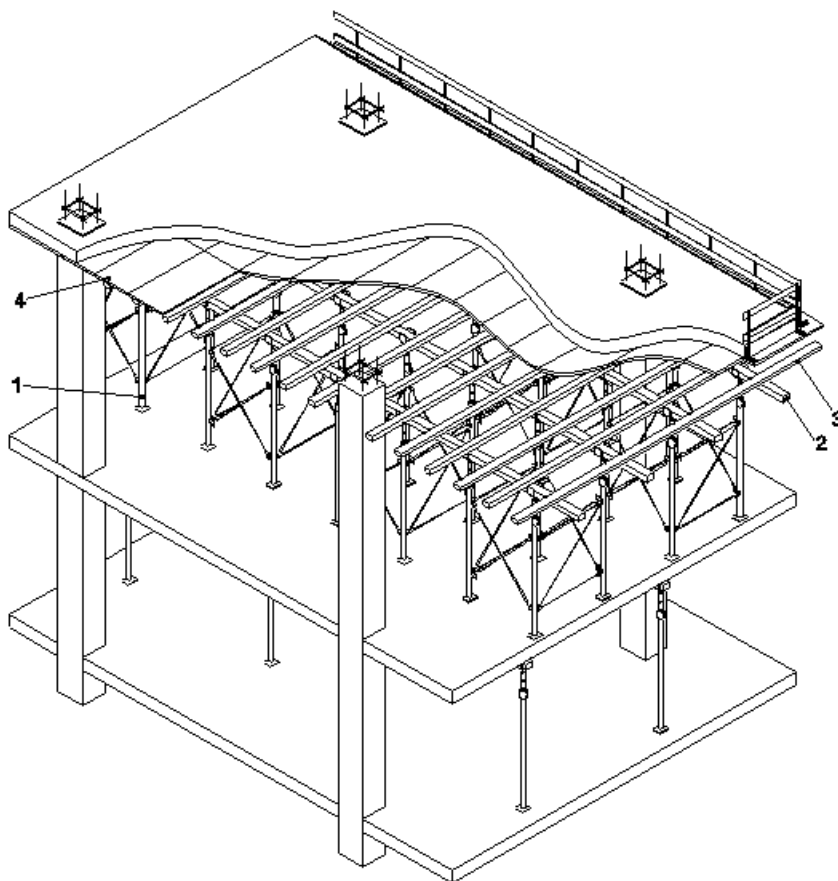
Опалубка перекрытия на основе опорных башен:
